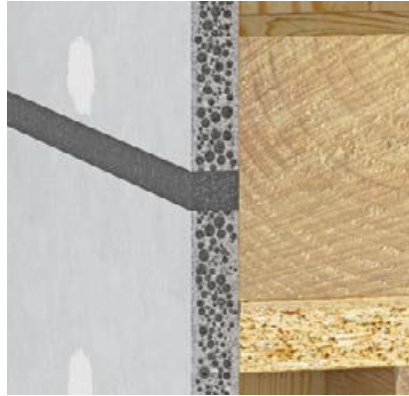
Verschließen der Fuge mit einem vorkomprimierten Dichtungsband (Detail)
